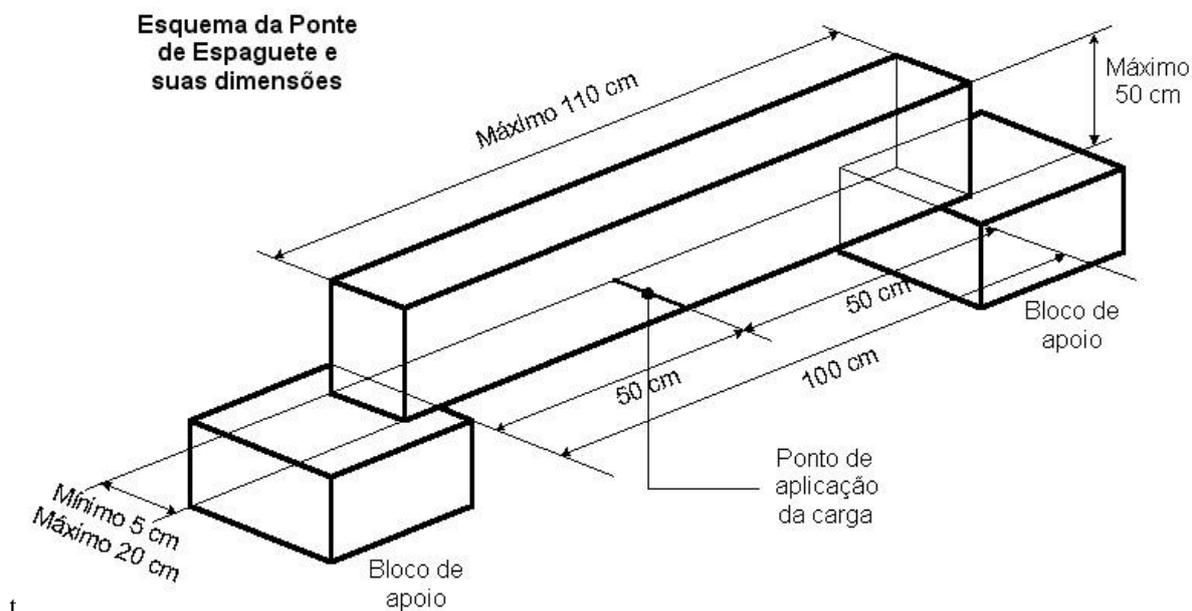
Desenho esquemático das dimensões da ponte e da bancada para ensaios destrutivos (UFRGS, 2018)
